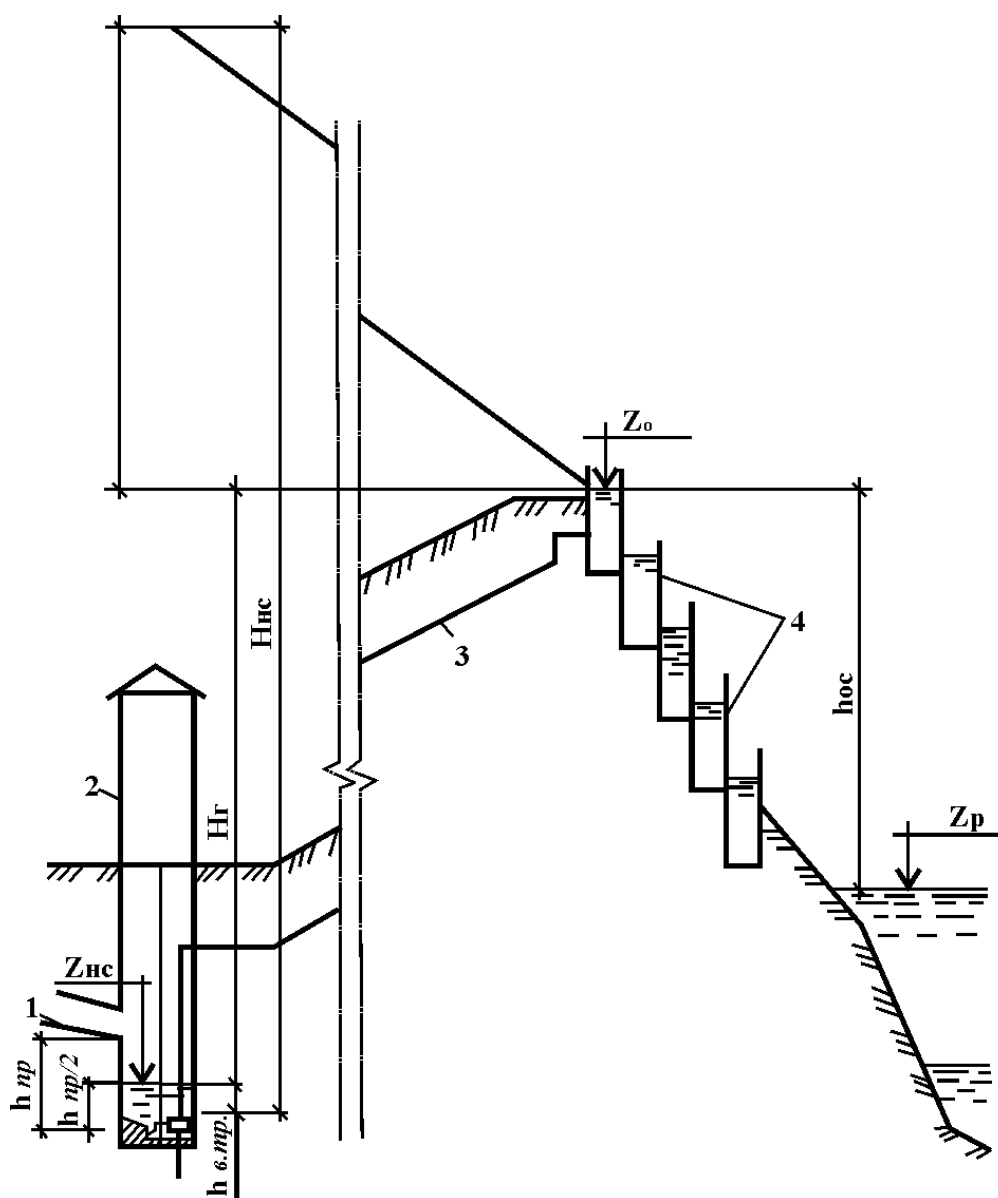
Высотная схема расположения насосной станции и напорного трубопровода: 1 – самотечный подводящий трубопровод; 2 – насосная станция; 3 – напорный трубопровод; 4 – очистные сооружения
